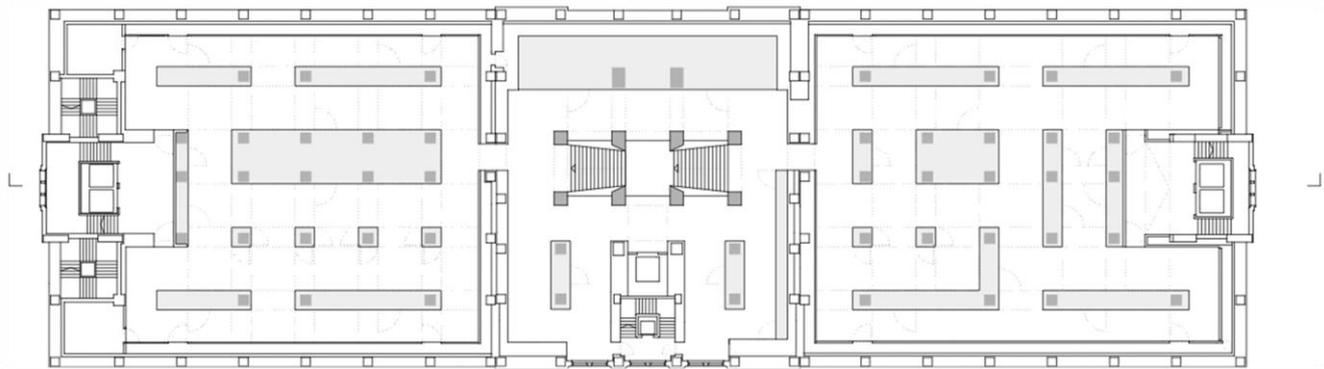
Planta piso 1, 1:500, Museu do Oriente. JLCG Arquitectos
